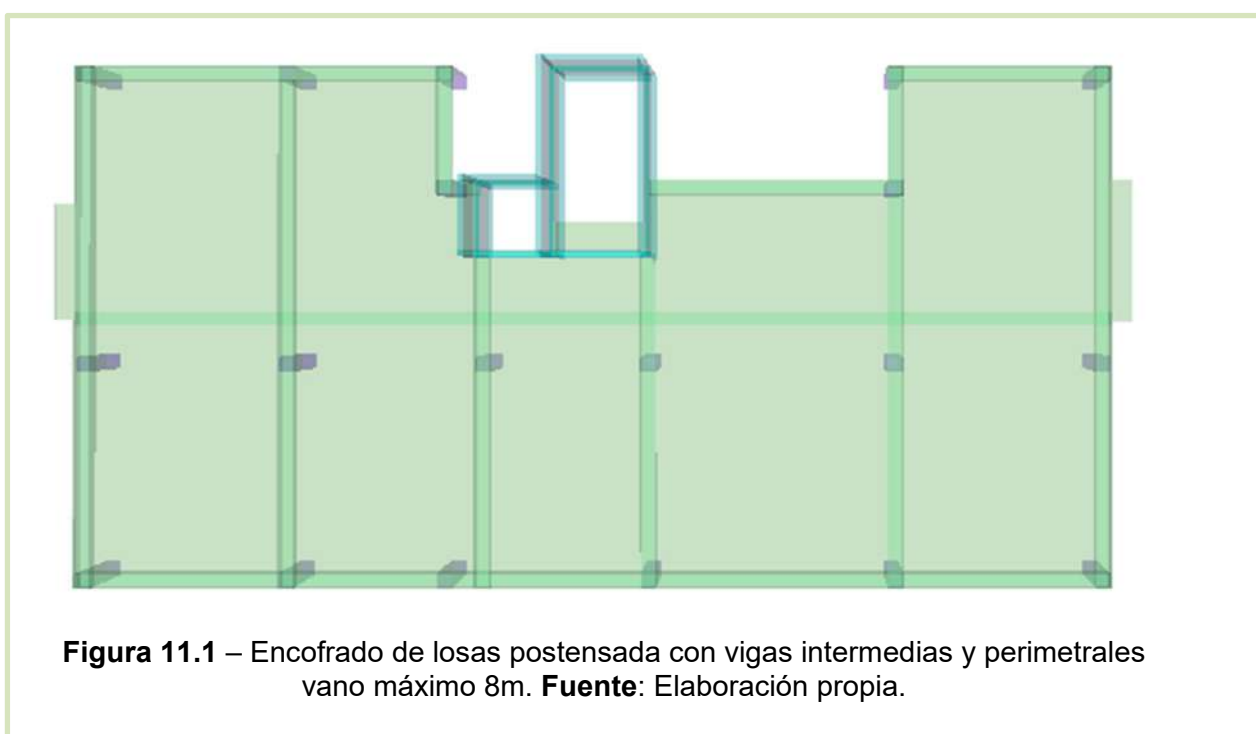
Encofrado de losas postensada con vigas intermedias y perimetrales vano máximo 8m. Fuente: Elaboración propia.
